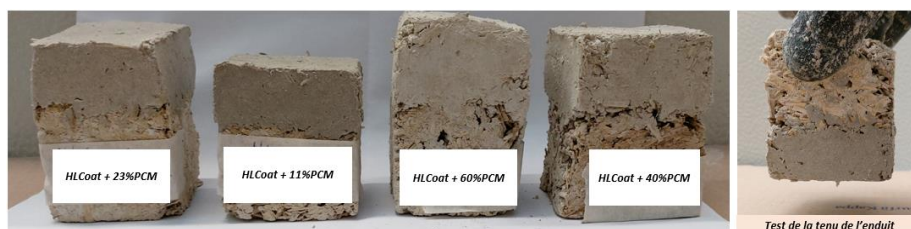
Tenue des enduits sur un support en béton de chanvre.
